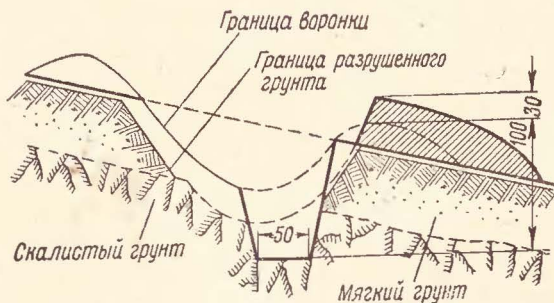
Профиль одиночного стрелкового окопа для стрельбы стоя, устроенный в воронке
